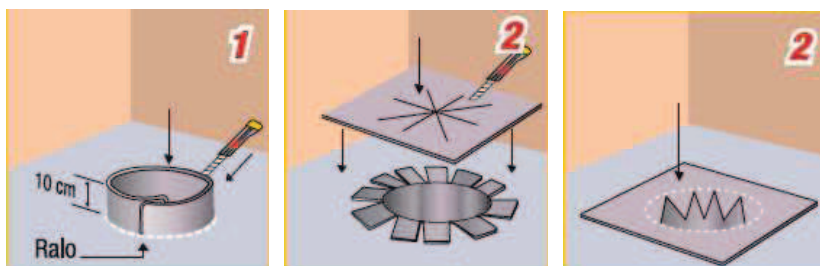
Detalhe da execução do reforço da impermeabilização dos ralos
